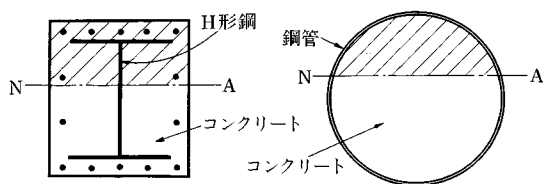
コンクリートのひびわれを許す合成断面の例
